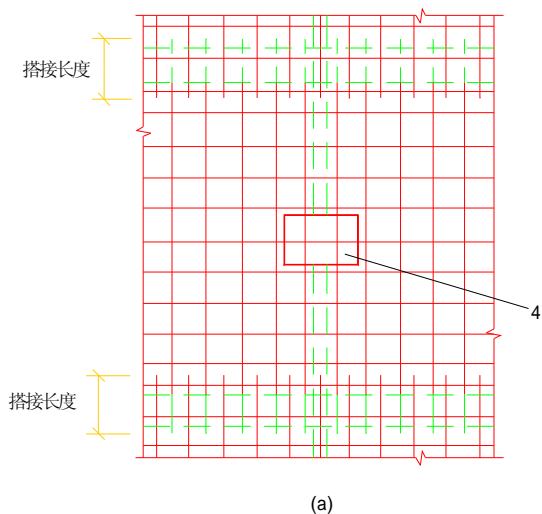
楼板上层钢筋焊接网与柱的连接(一)
